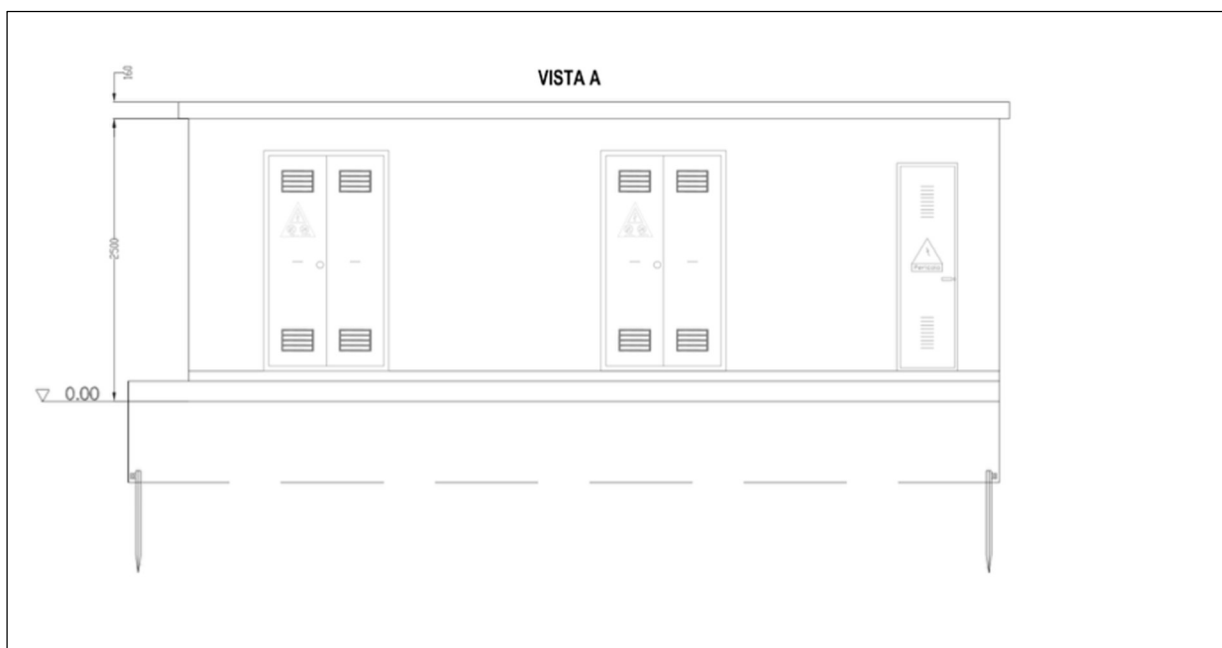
Locale cabina di Parallelo Mt-Prospetto
